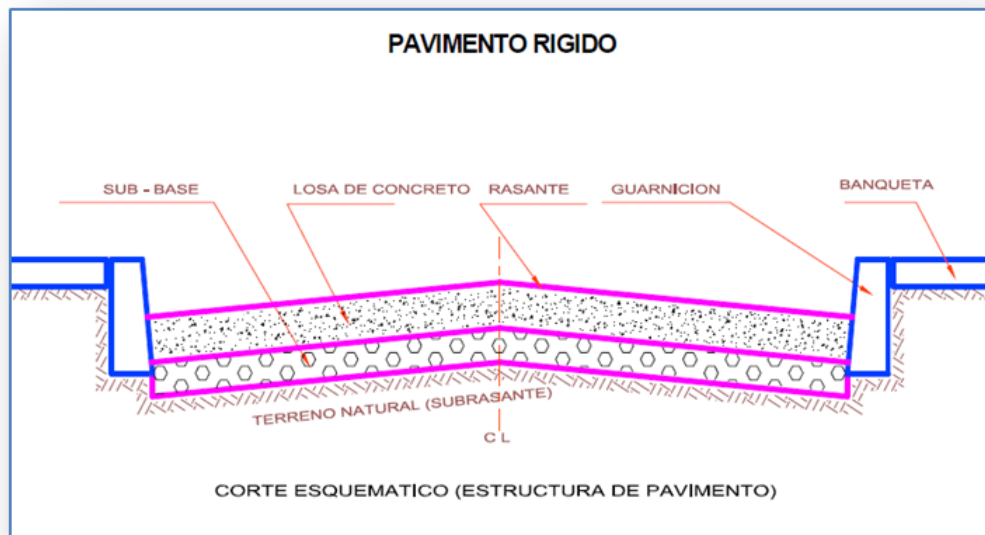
Corte esquemático con cada una de las partes de un pavimento rígido
